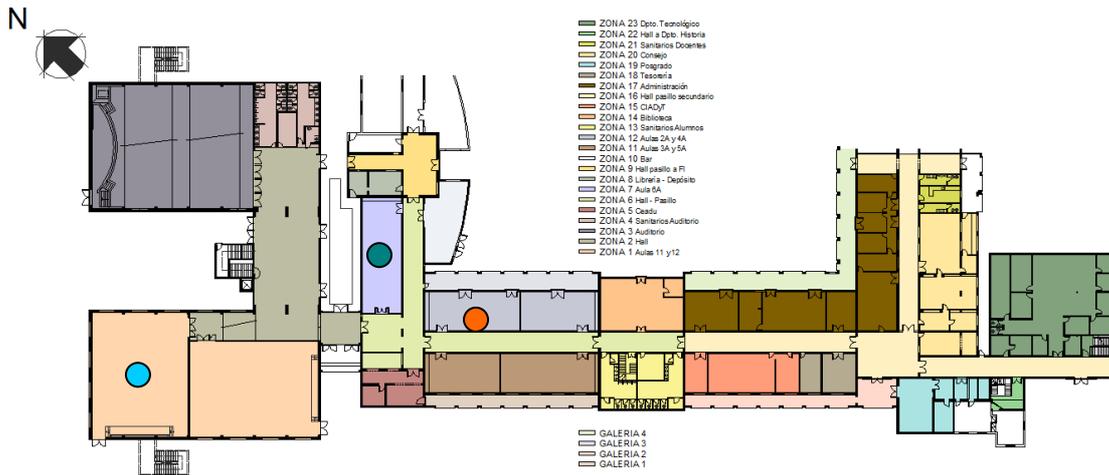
Zonificación Planta Baja – FAU – UNNE y Relevamiento y Monitoreo térmico. Ubicación de sensores de temperatura en planta baja. Referencias: ● Aula 4 ● Aula 6 ● Aula 11
